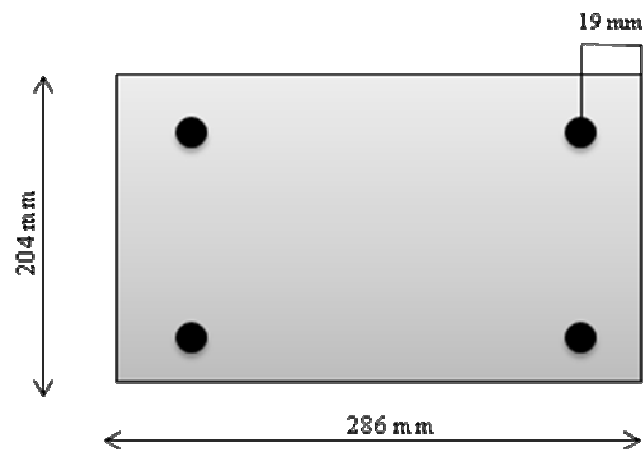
Dimensiones de la plancha frontal. [Fuente propia]
